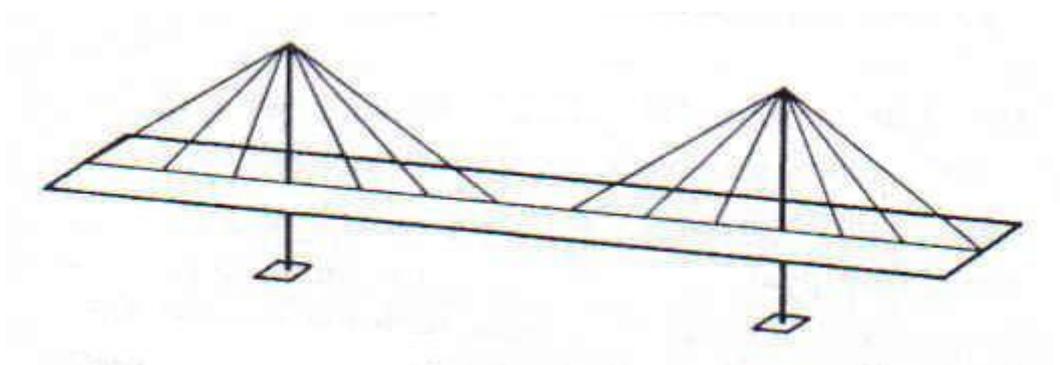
Dos planos de cables colocados al borde de la estructura
